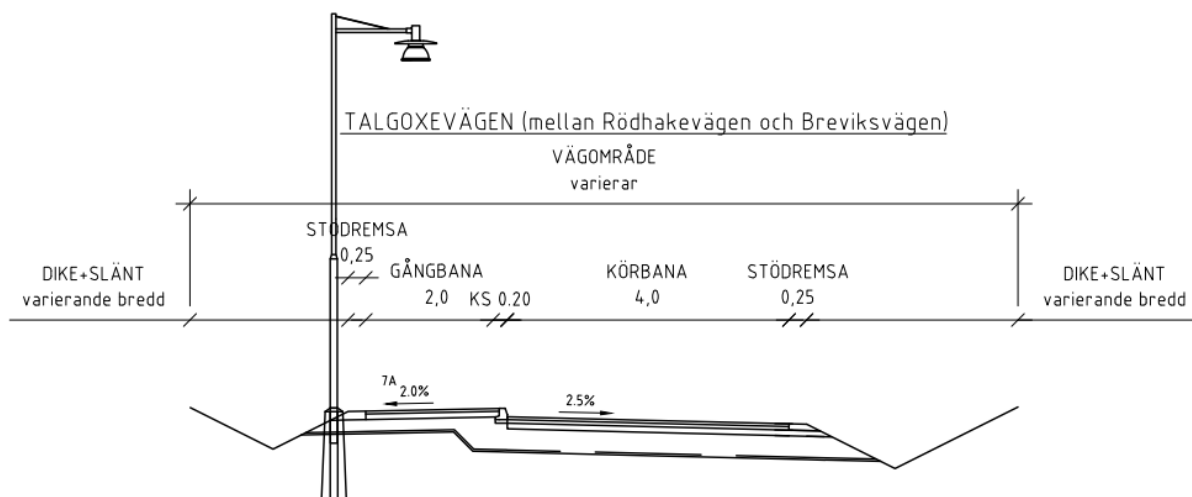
Typsektion för Talgoxevägen mellan Rödhakevägen och Breviksvägen.
